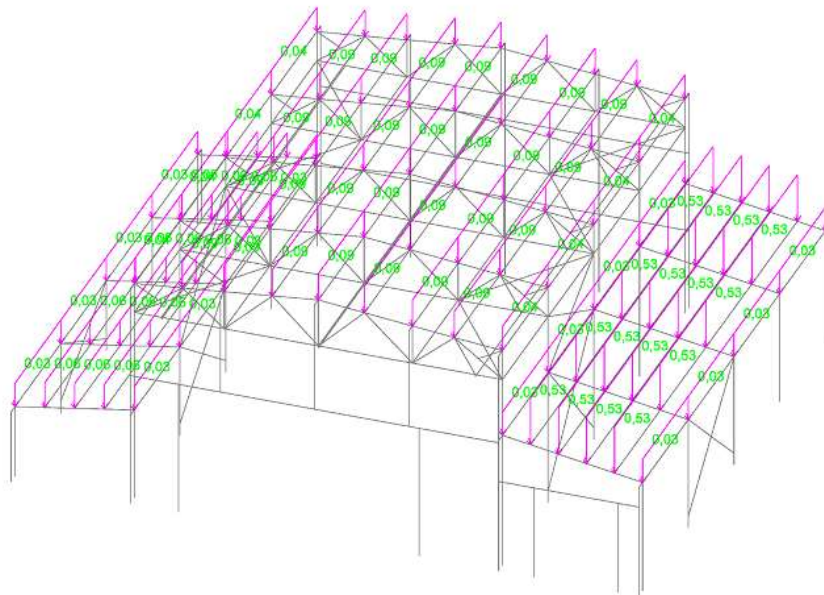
Схема загрузки постоянной нагрузкой от собственного веса кровельных панелей
